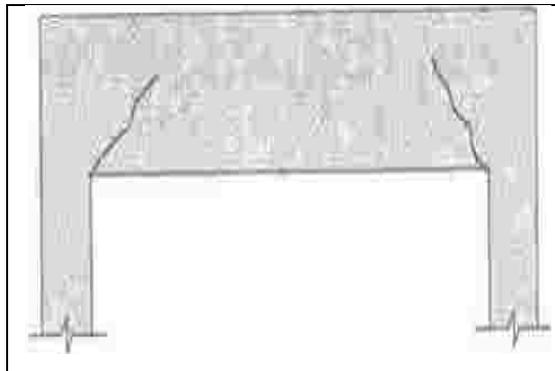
Fisuras inclinadas en los extremos de la viga¹⁴
